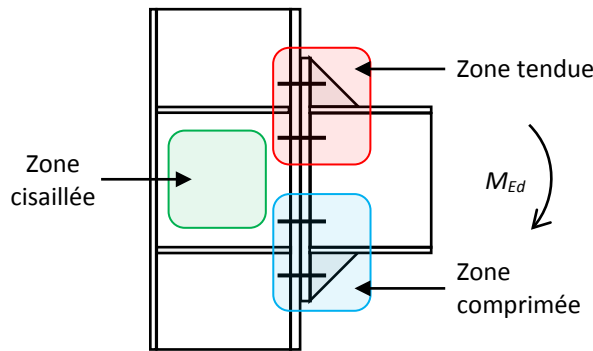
Zones critiques dans les assemblages poutre-poteau
